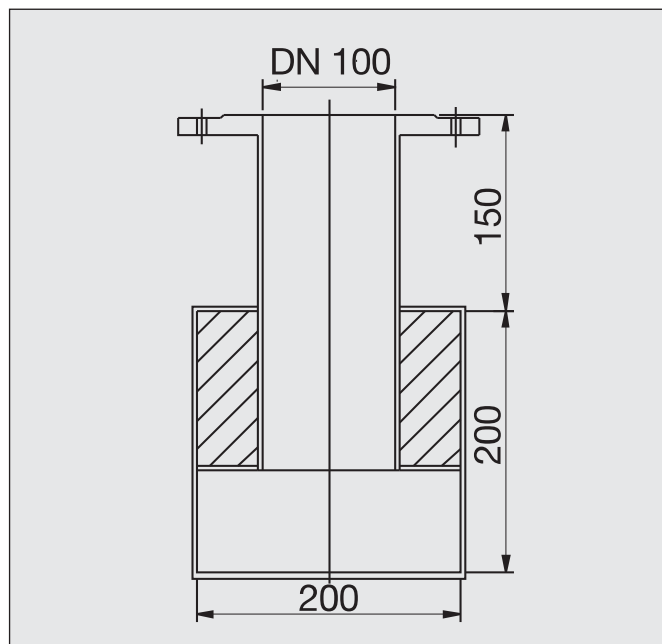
Hrdla přírub v jedné rovině, standardní délky 150mm
